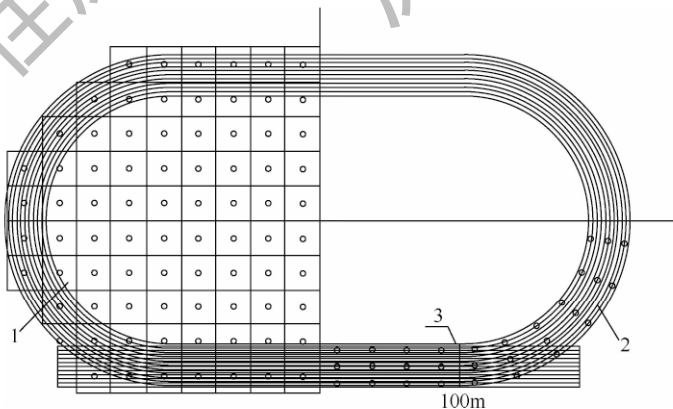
田径场场地照度测量网格点布置图（对称布置）
